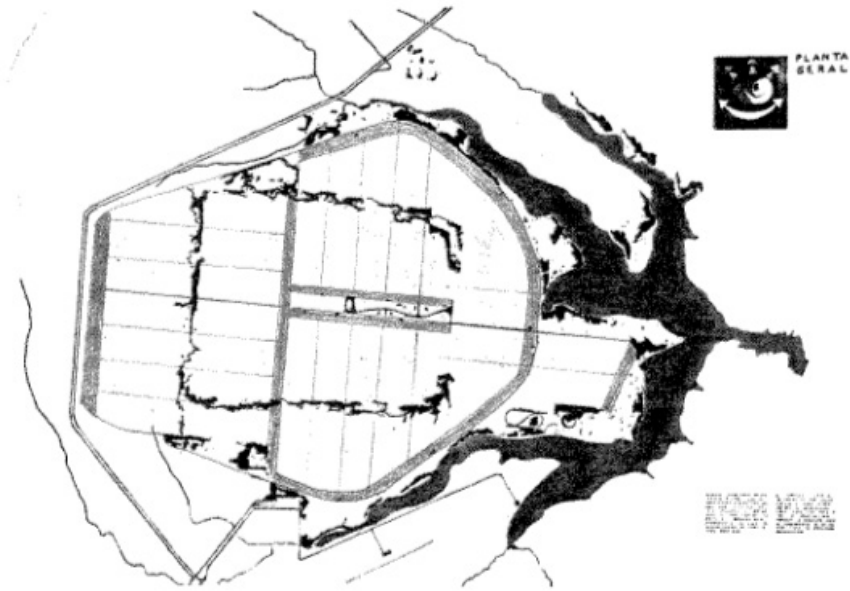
Planta geral do plano nº 17, de Jorge Wilhelm (Fonte: Costa, 2002).
